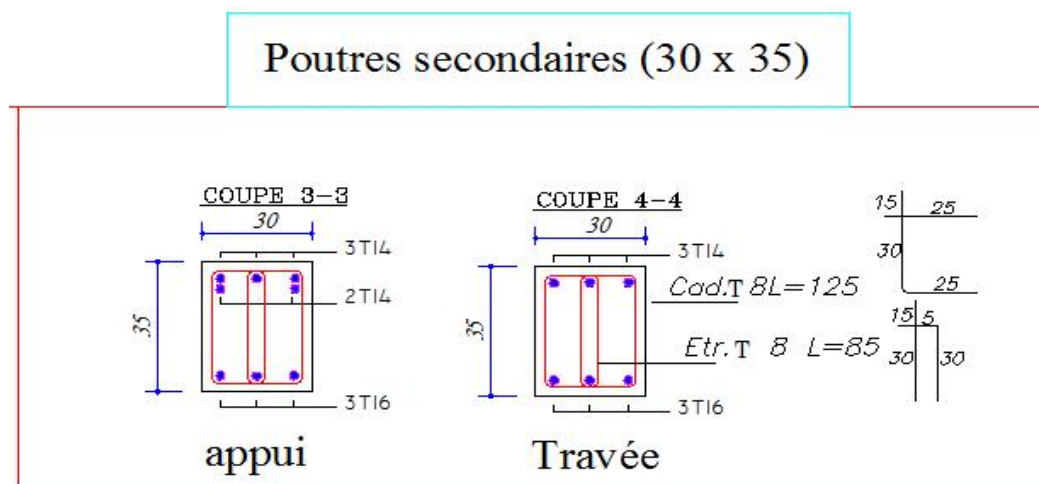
Schéma de ferrailage des poutres secondaires.
